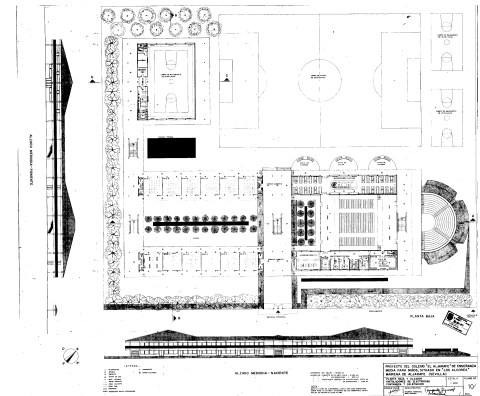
Planta baja y secciones abatidas. Planos originales. Fondo Fundación Aljarafe.
